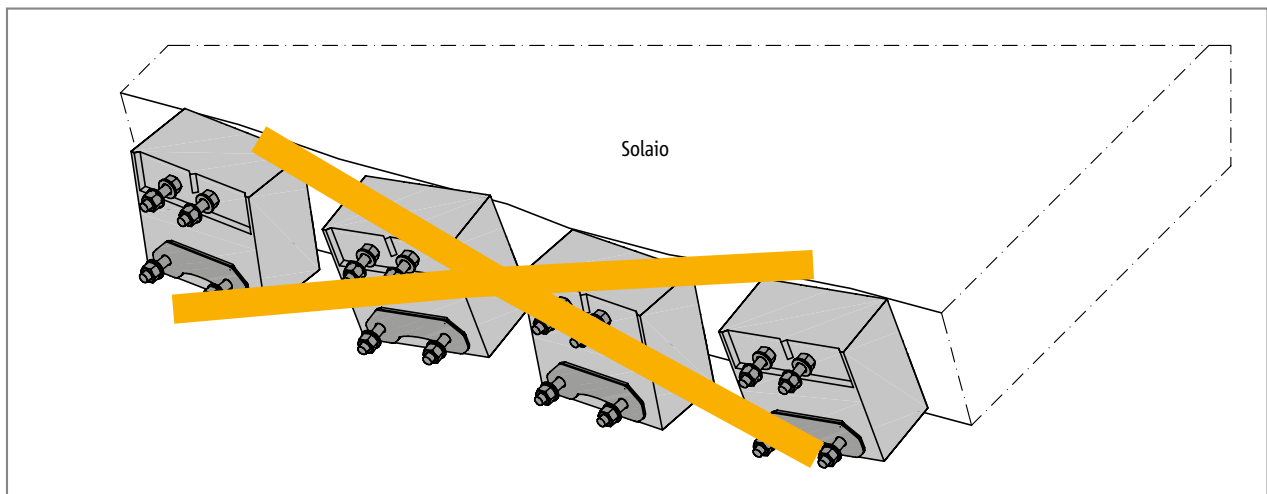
Schöck Isokorb®: la torsione e lo spostamento degli elementi a causa di un fissaggio non eseguito correttamente durante la posa
